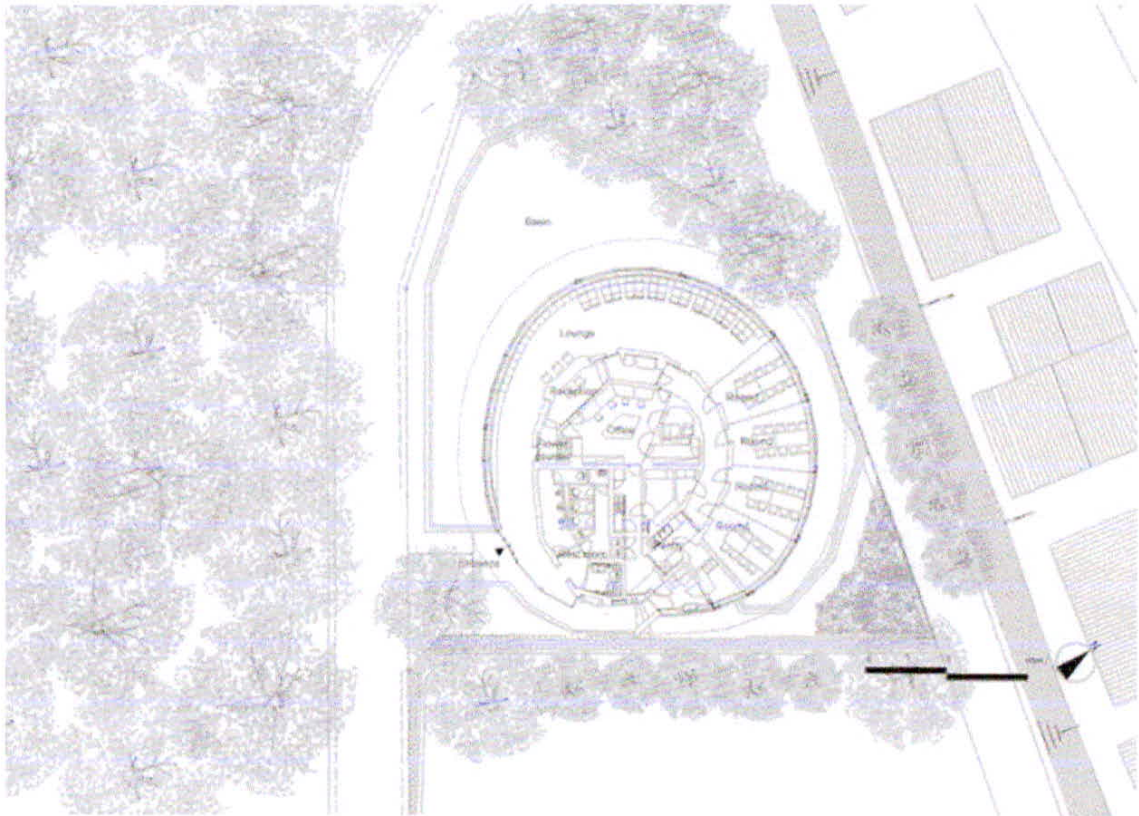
Planta baixa do edifício. Fonte: (Arch Daily, 2016).
